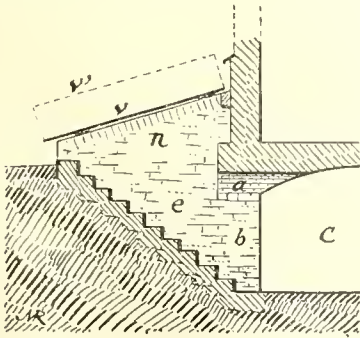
Coupe verticale d'une descente extérieure de cave.
